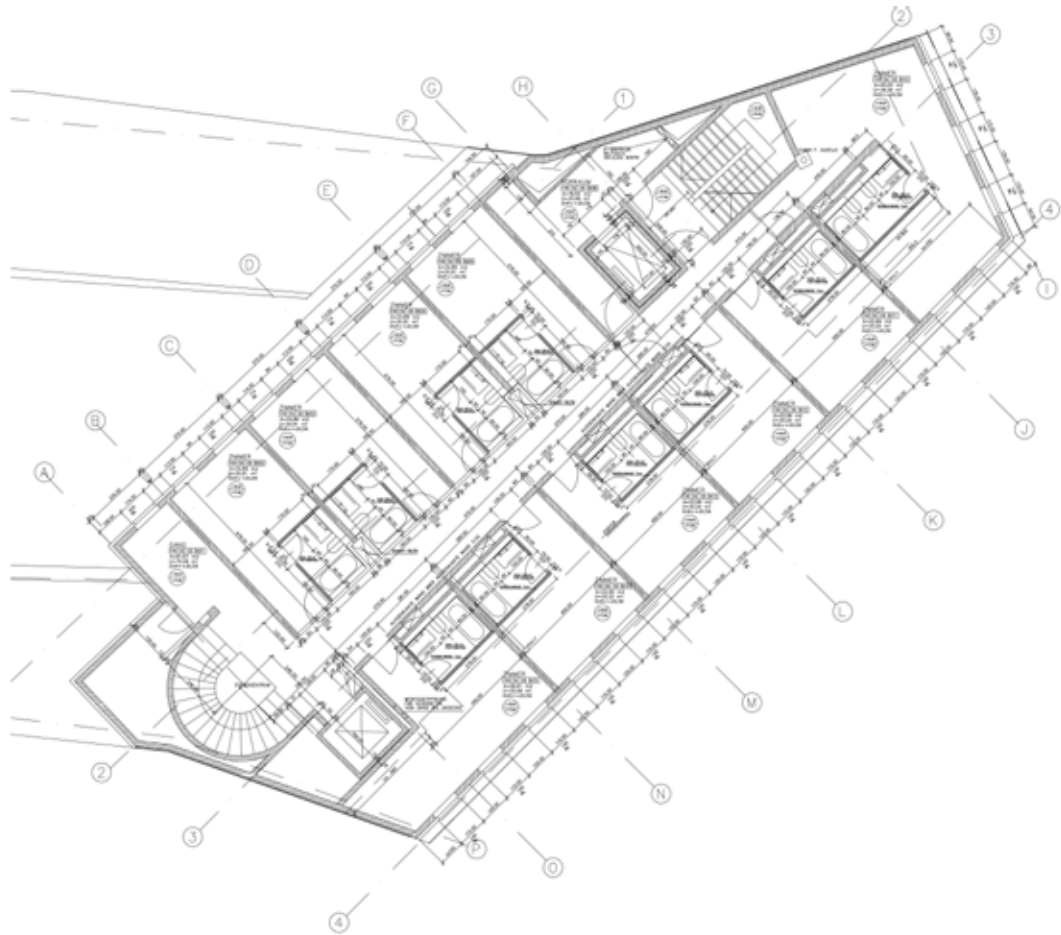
\_ Grundriss © Peter Lorenz Ateliers
